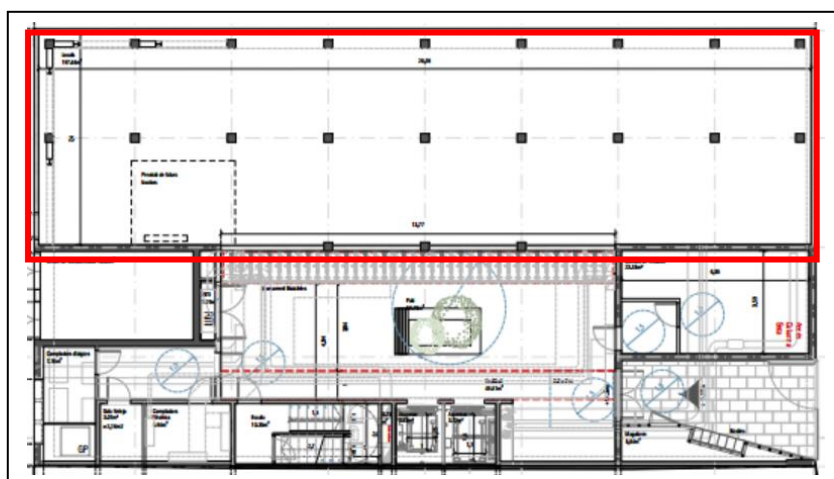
Ubicación en planta baja del recinto emisor del ensayo ACU-24-119841 (26).
